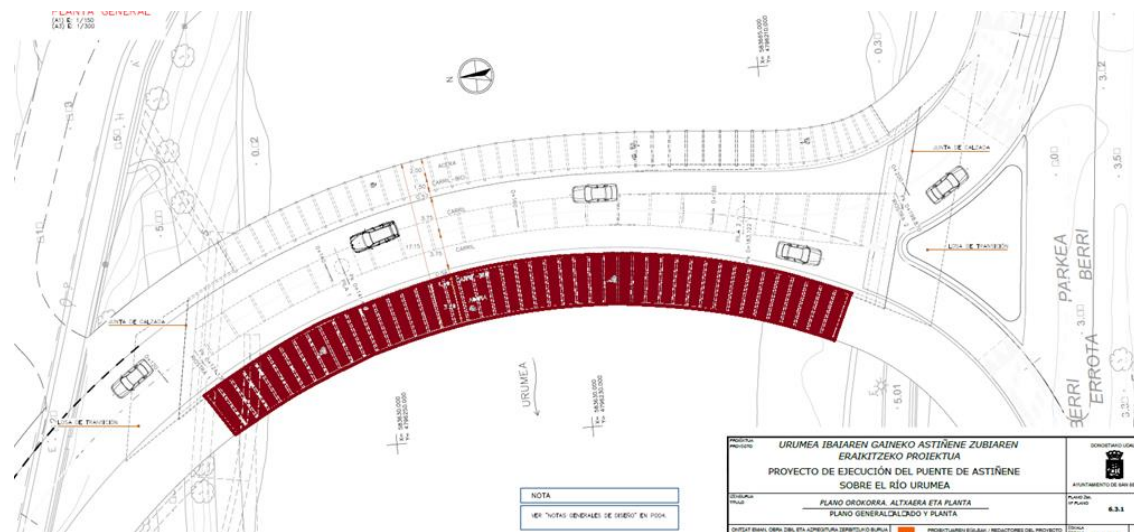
Planta general con modificación del carril bici en el tramo señalado (Fuente: elaboración propia)
